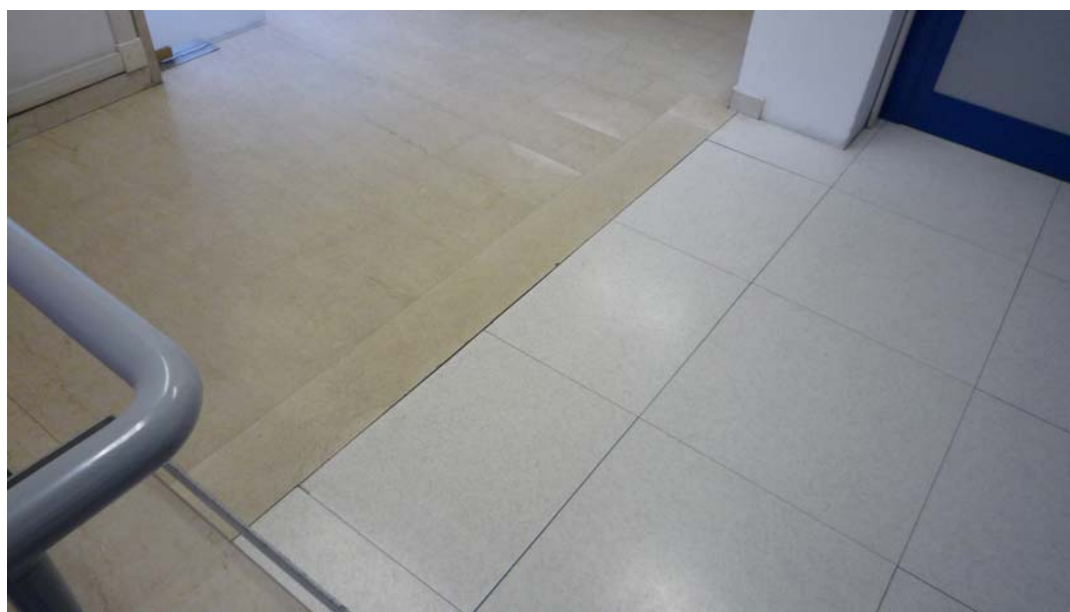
Pavimenti in marmo botticino semiclassico e pavimento galleggiante – ingresso ala est
